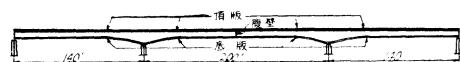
は連続桁部分の底版頂版および腹壁の施工継手の位置を示すものである。コンクリートは底版、腹壁および隔壁、頂版の順序で施工した。底版のコンクリート打設に先立つて、この部分の死荷重による理論的タワミに対応して型ワクにキャンバーをつけた。そのためには支保トラスの各格点に $6.5 \text{ in} \cdot 10 \text{ t}$ の水圧ジャッキを置き、底版を持ち上げて、クサビをかまし、かつ腹壁、隔壁および頂版のコンクリートの施工中においても底版を計画高に保つようにした。内側の型ワク取りはずしの便宜のために底版に一時的な孔を設けておき、型ワクを取りはずしたのちコンクリートを填充してふさいだ。
